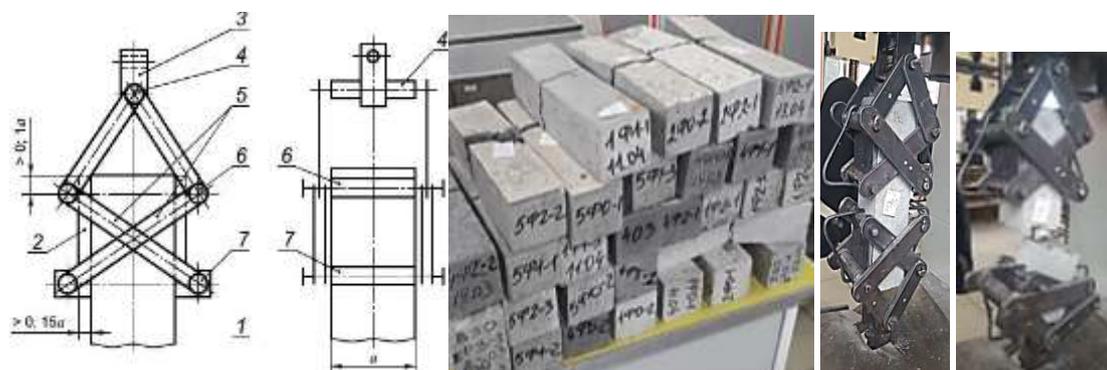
Схема саморегулируемого зажима и внешний вид испытанных образцов:
